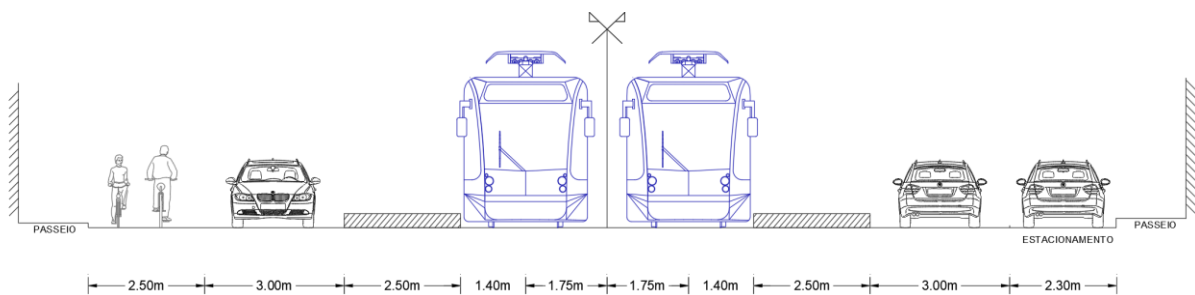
Perfil Transversal Tipo (Paragem – Cais Lateral – Tipo 1)
